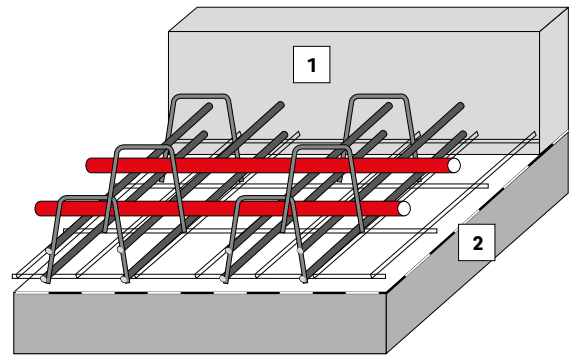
Mit Stahlmatten bewehrte Bodenplatte; Sonderkonstruktion Heizungsrohre mittig in der Platte montiert
